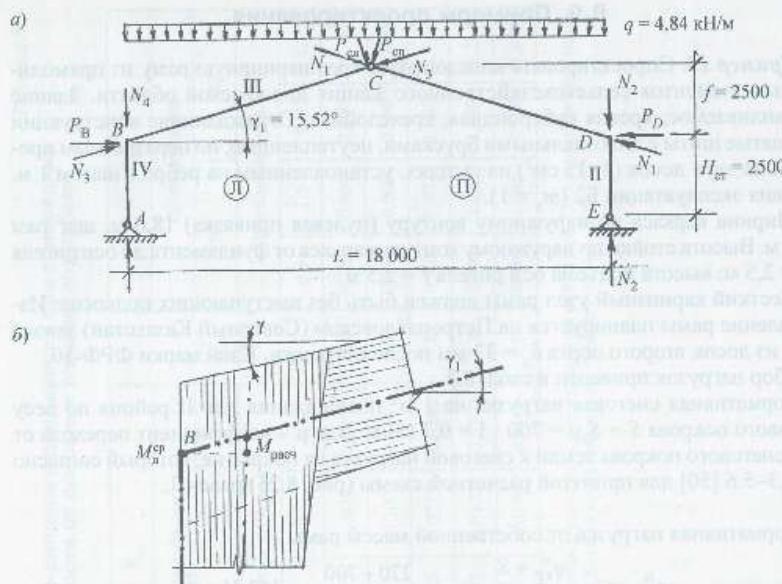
Расчетные схемы: а – рамы по наружному контуру стоек и оси ригеля для расчета на ЭВМ; б – карнизного узла для переноса усилий на ось рамы
